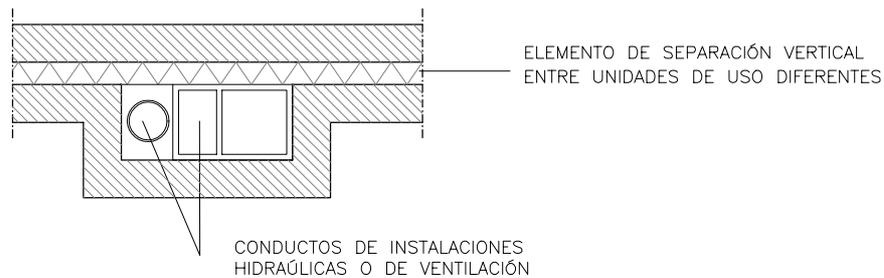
Vista en planta del encuentro de un elemento de separación vertical con conductos de instalaciones.
